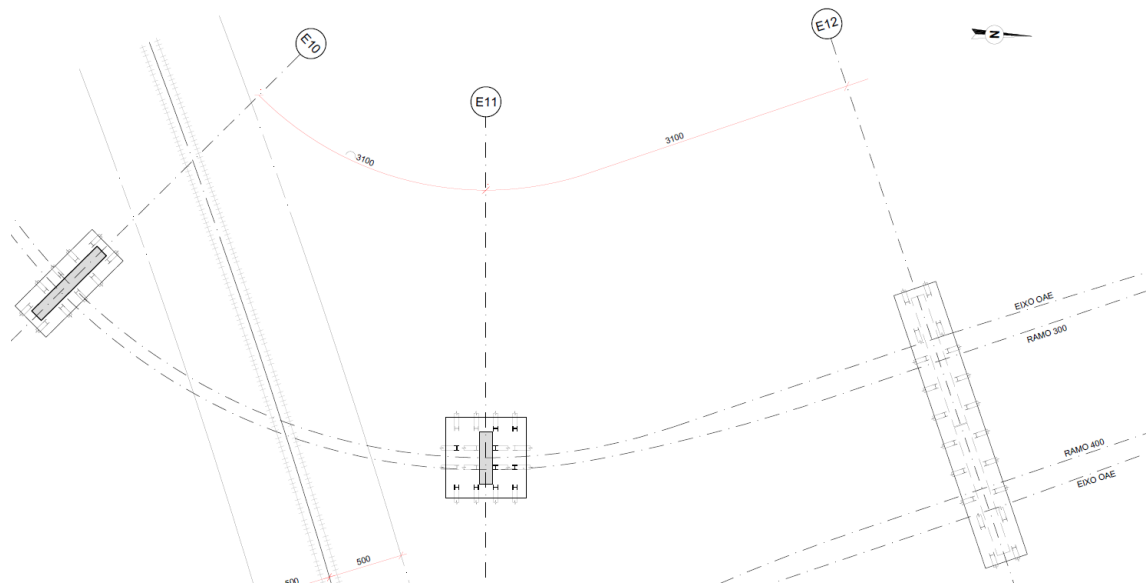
DISTRIBUIÇÃO DAS ESTRUTURAS DE FUNDAÇÃO – EIXOS E10 AO E12 (RAMO 300)
